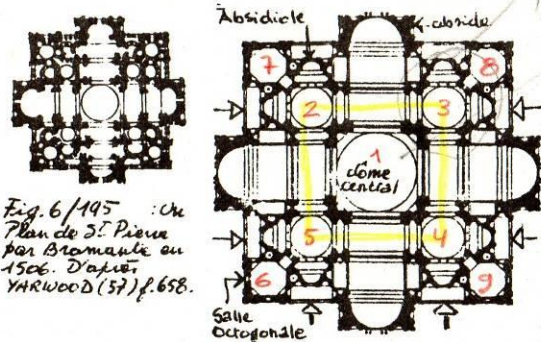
/195 : Plan de St Pierre par Bramante en 1506. D'après YARWOOD (37) p. 658.
